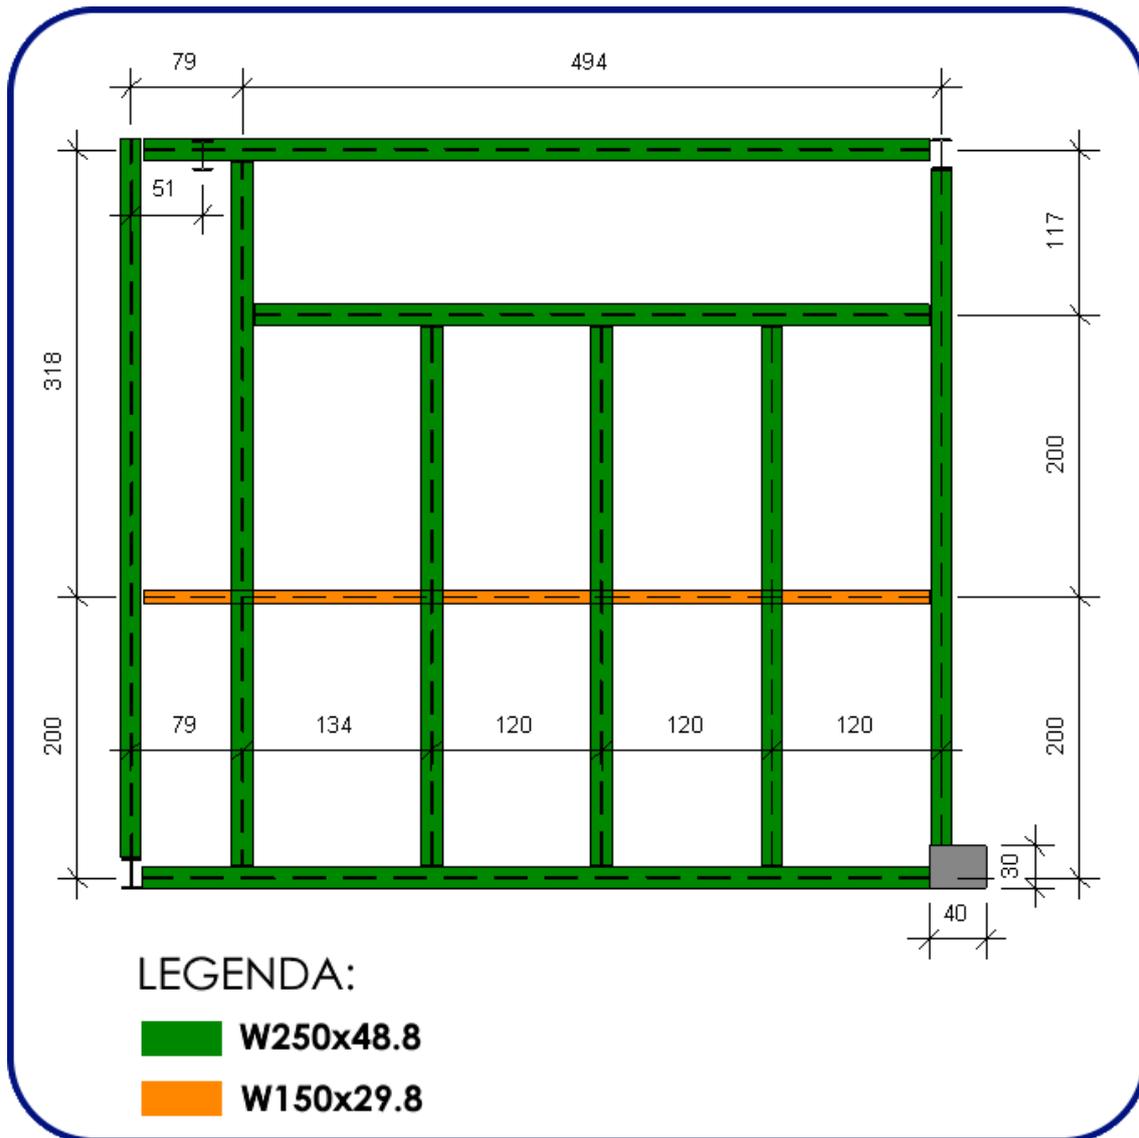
Modelo 3D da disposição das vigas do mezanino.
